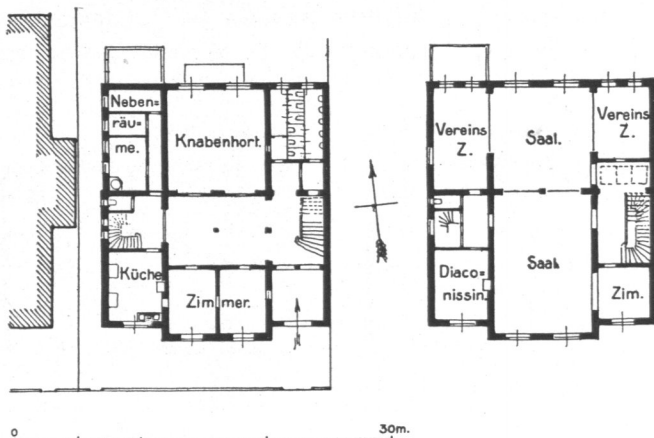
und 144. Gemeindehaus in Rotenburgsort, Grundrisse.
